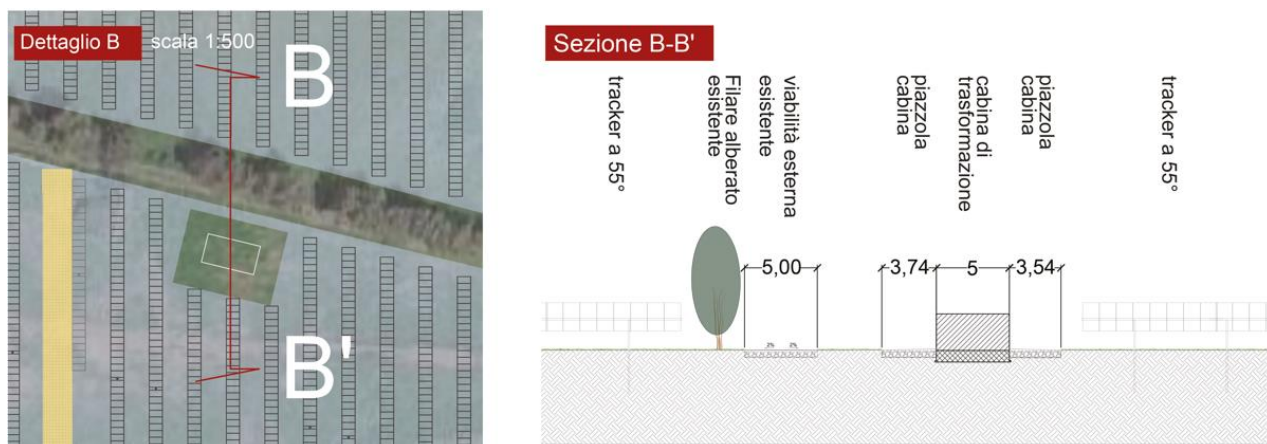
PARTICOLARE FASCIA DI MITIGAZIONE E CABINA DI TRASFORMAZIONE – SEZIONE N-S DELL’IMPIANTO – ESTRATTO DALL’ELABORATO GRAFICO MAC2-PDT11)
